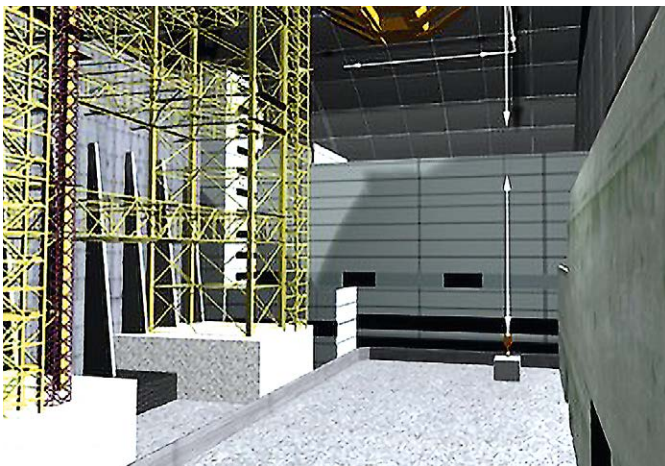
Схема руху екранованої кабіни в район ЗВР із демонтажу ферми за допомогою крана НБК
